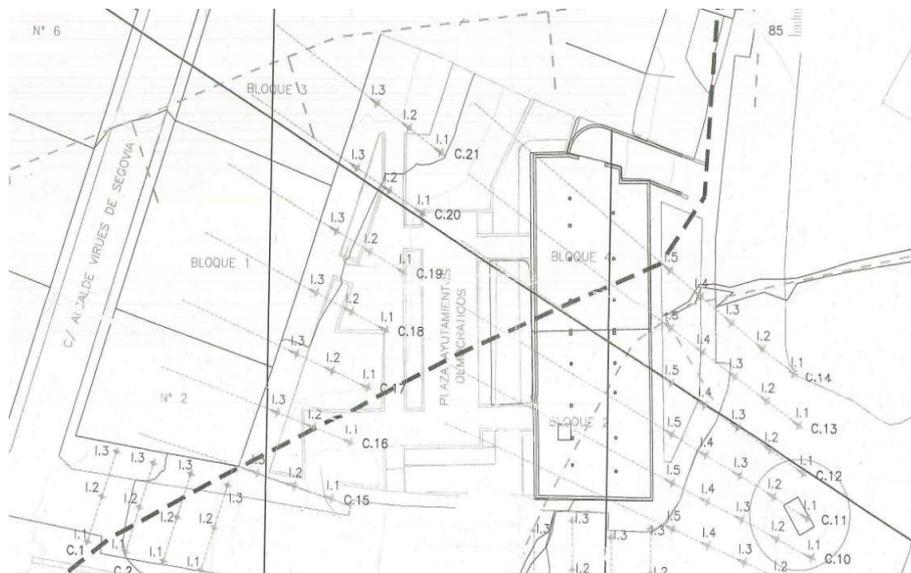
Planta de distribución de contrafuertes de inyecciones armadas y drenes subhorizontales (trazos discontinuos en azul). Archivos del estudio de D. Emilio Yanes Bustamante (2011)
